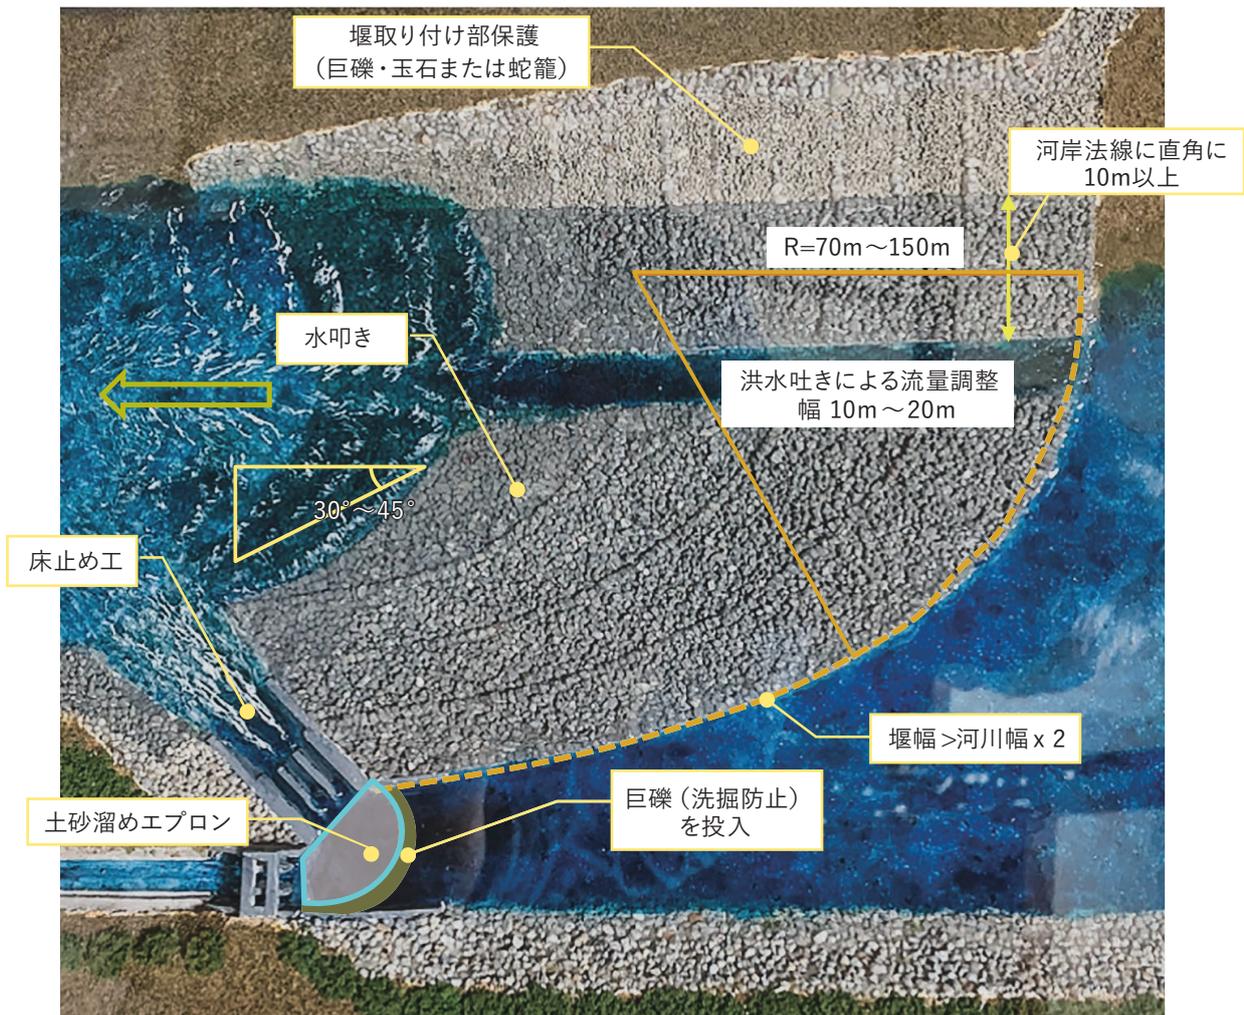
巨礫積み斜め堰の平面図<sup>2)</sup>
